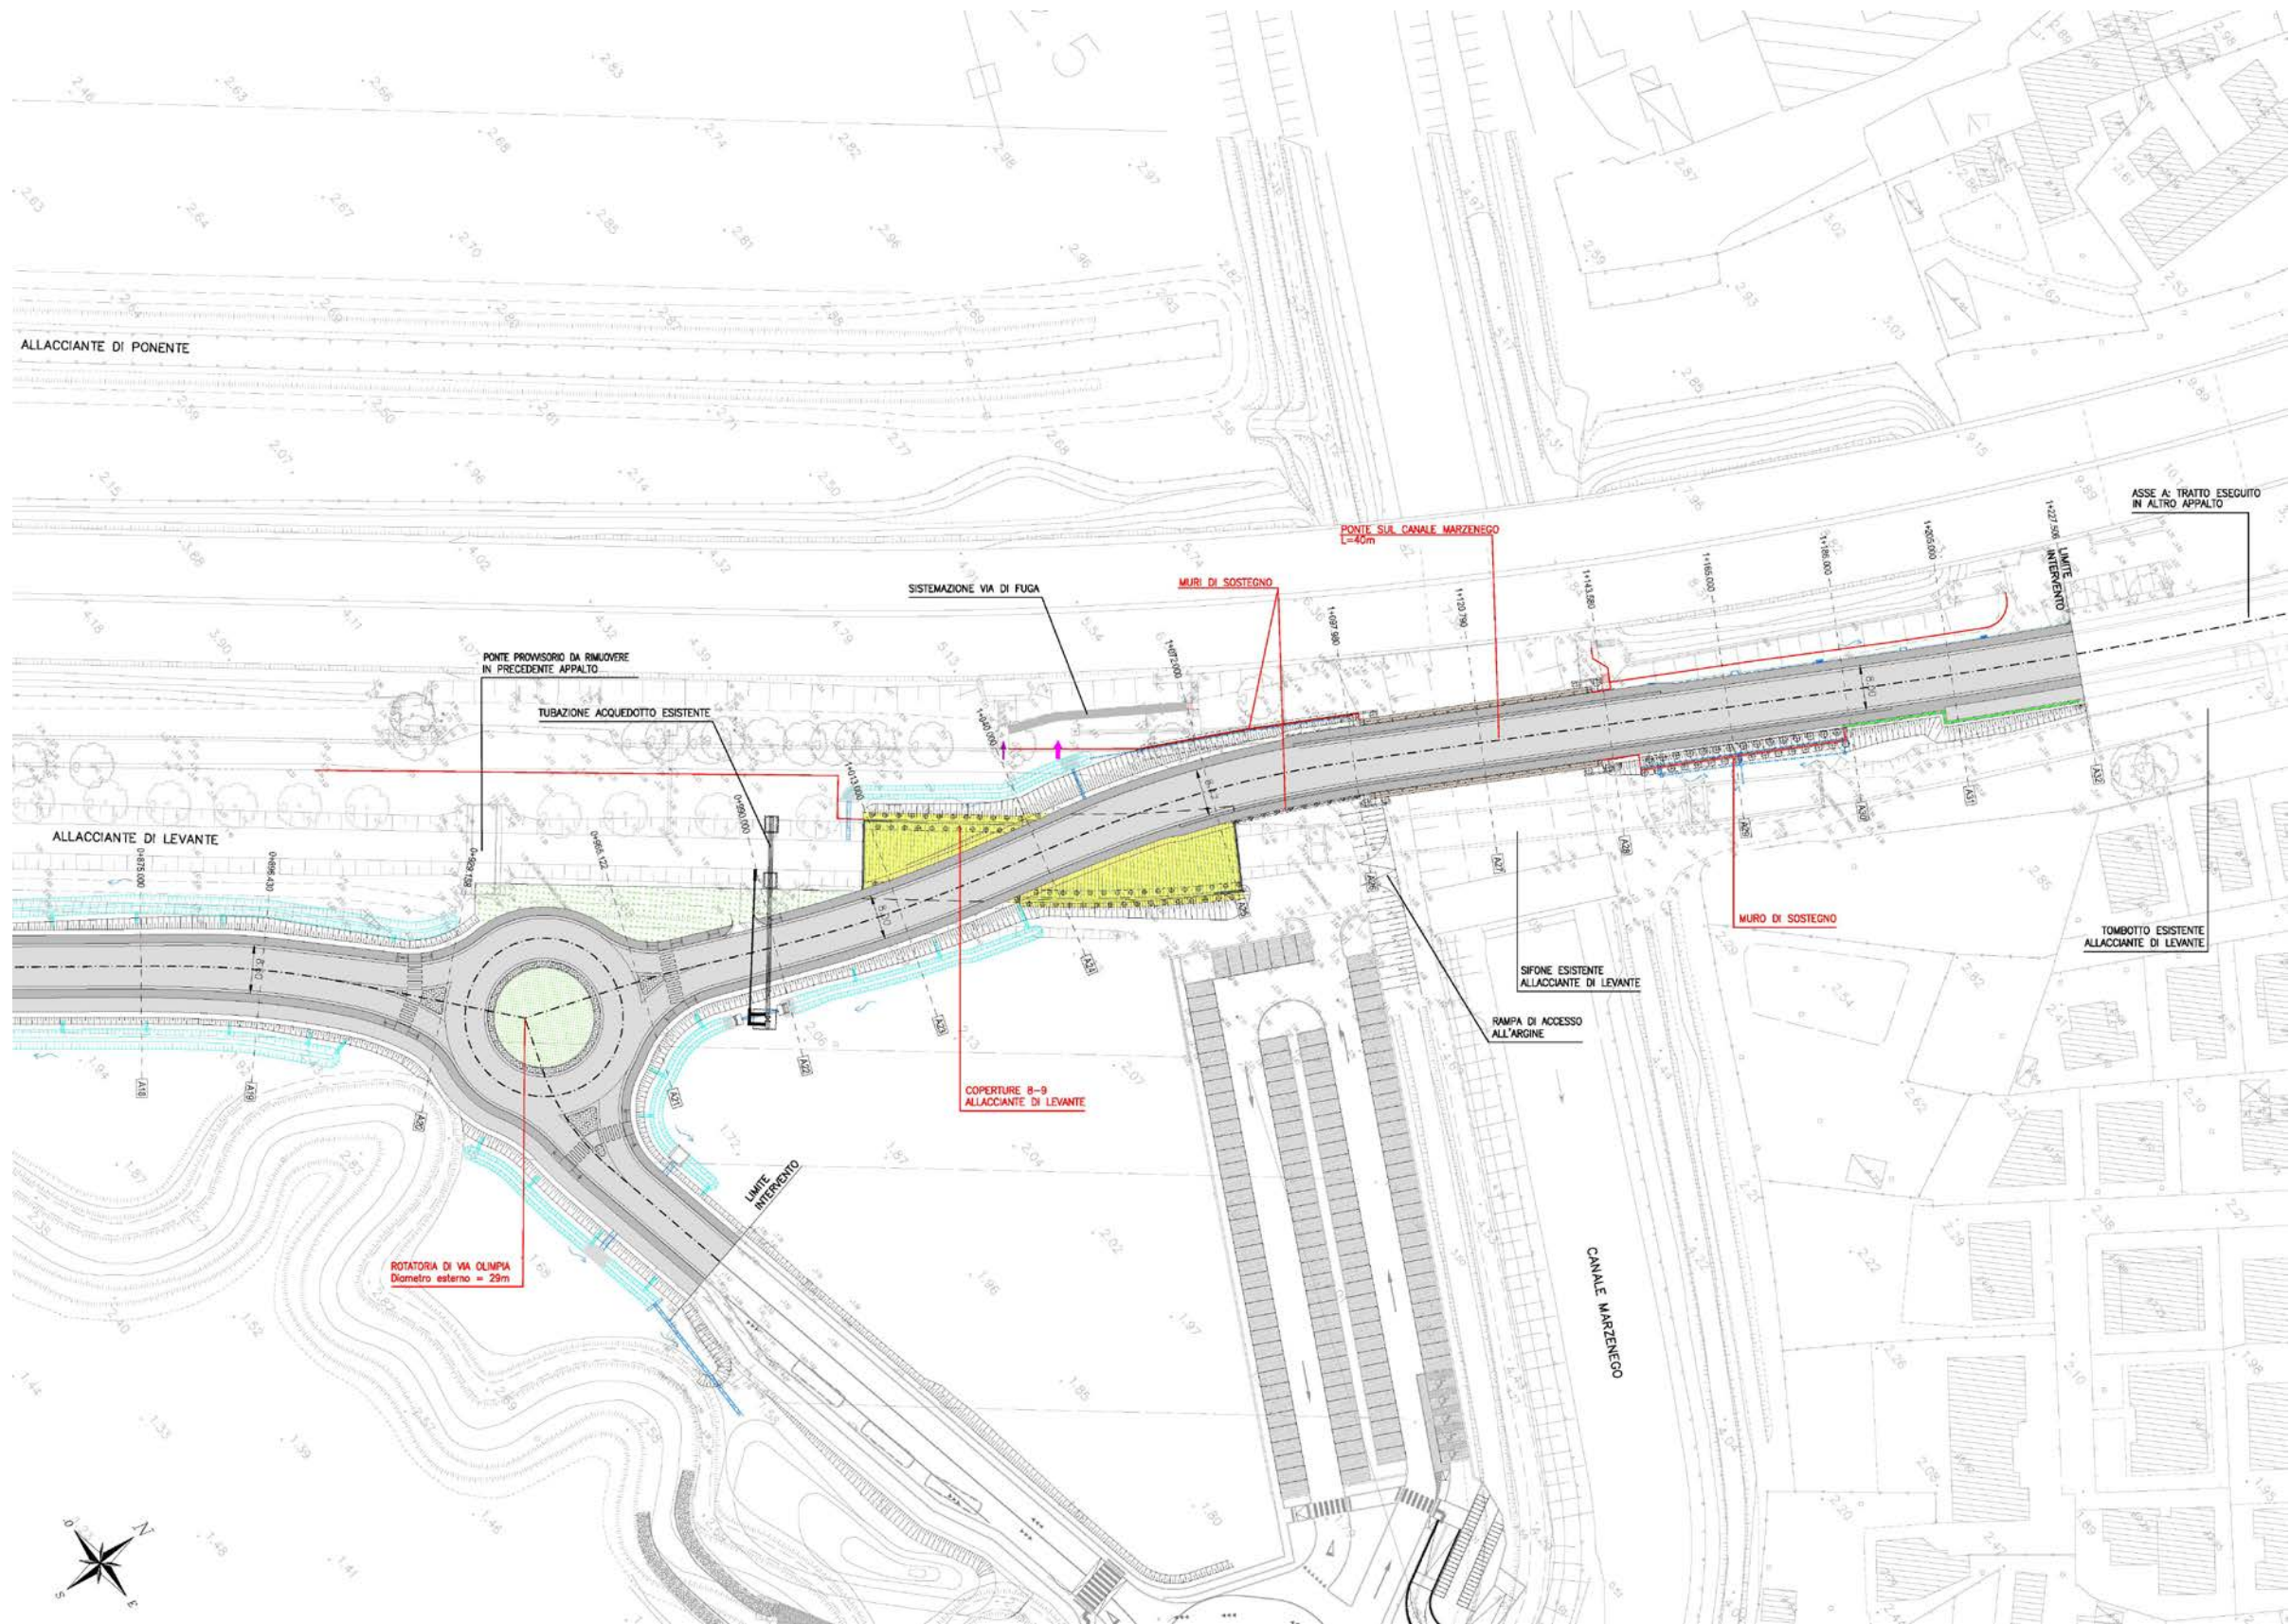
Intervento 1.09bis – Planimetria zona nord
